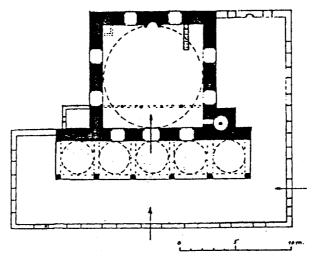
مسقط أفقي لمسجد الفاتح في كستنديل (عن: ايفردي).
